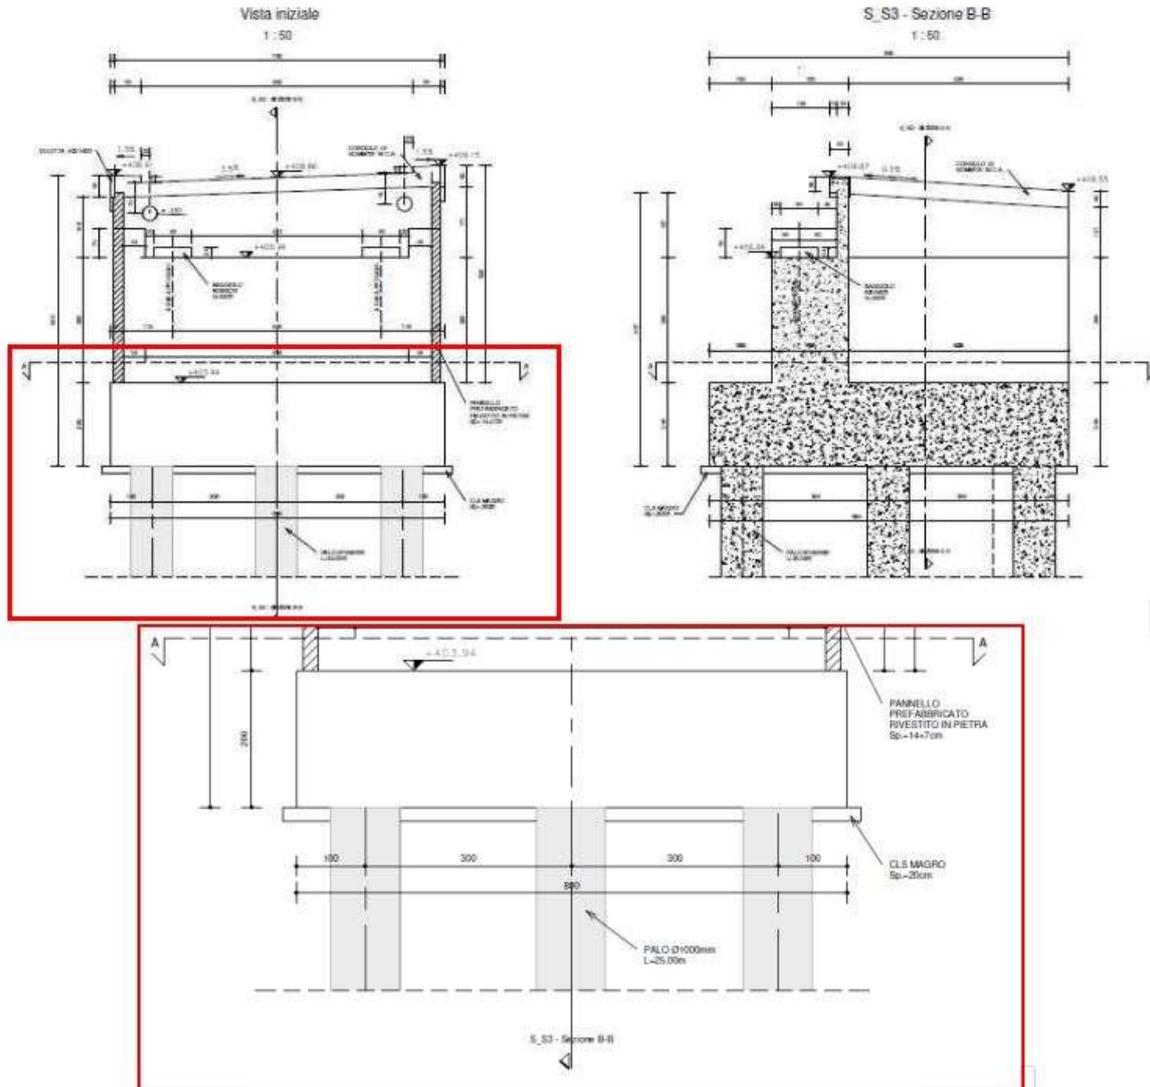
Spalla S3 - prospetto, sezione e dettaglio fondamenta
